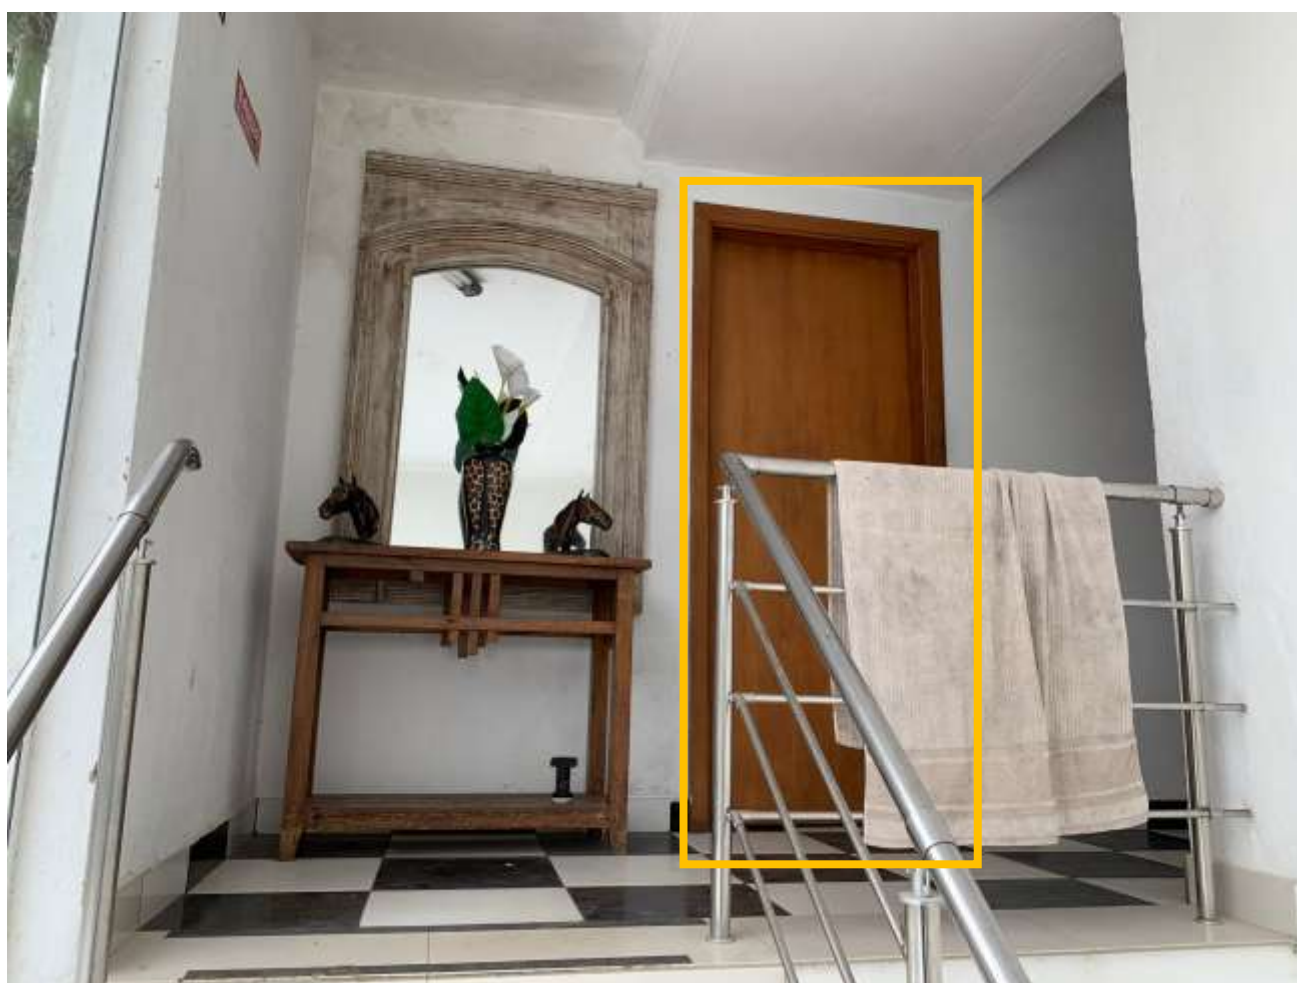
Detalhe da chegada ao segundo pavimento da edificação. Conforme marcação em amarelo, informo que neste ambiente não foi possível ter acesso pois os funcionários no local não estavam portando as chaves.
